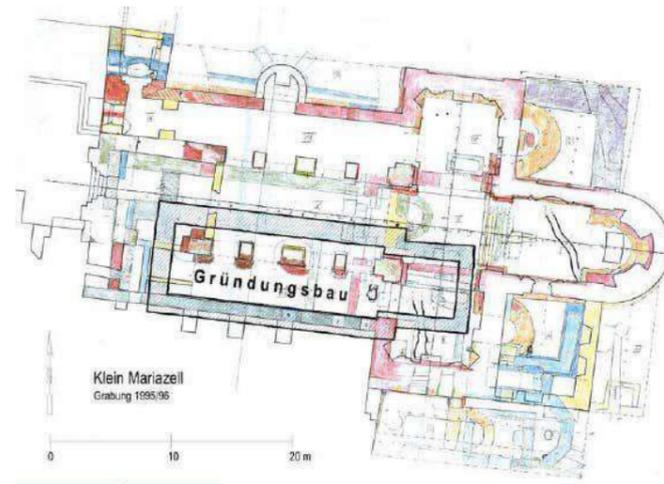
Grabungsplan des Klosters der Jahre 1995/96 mit Nachzeichnung des Gründungsbaues.
